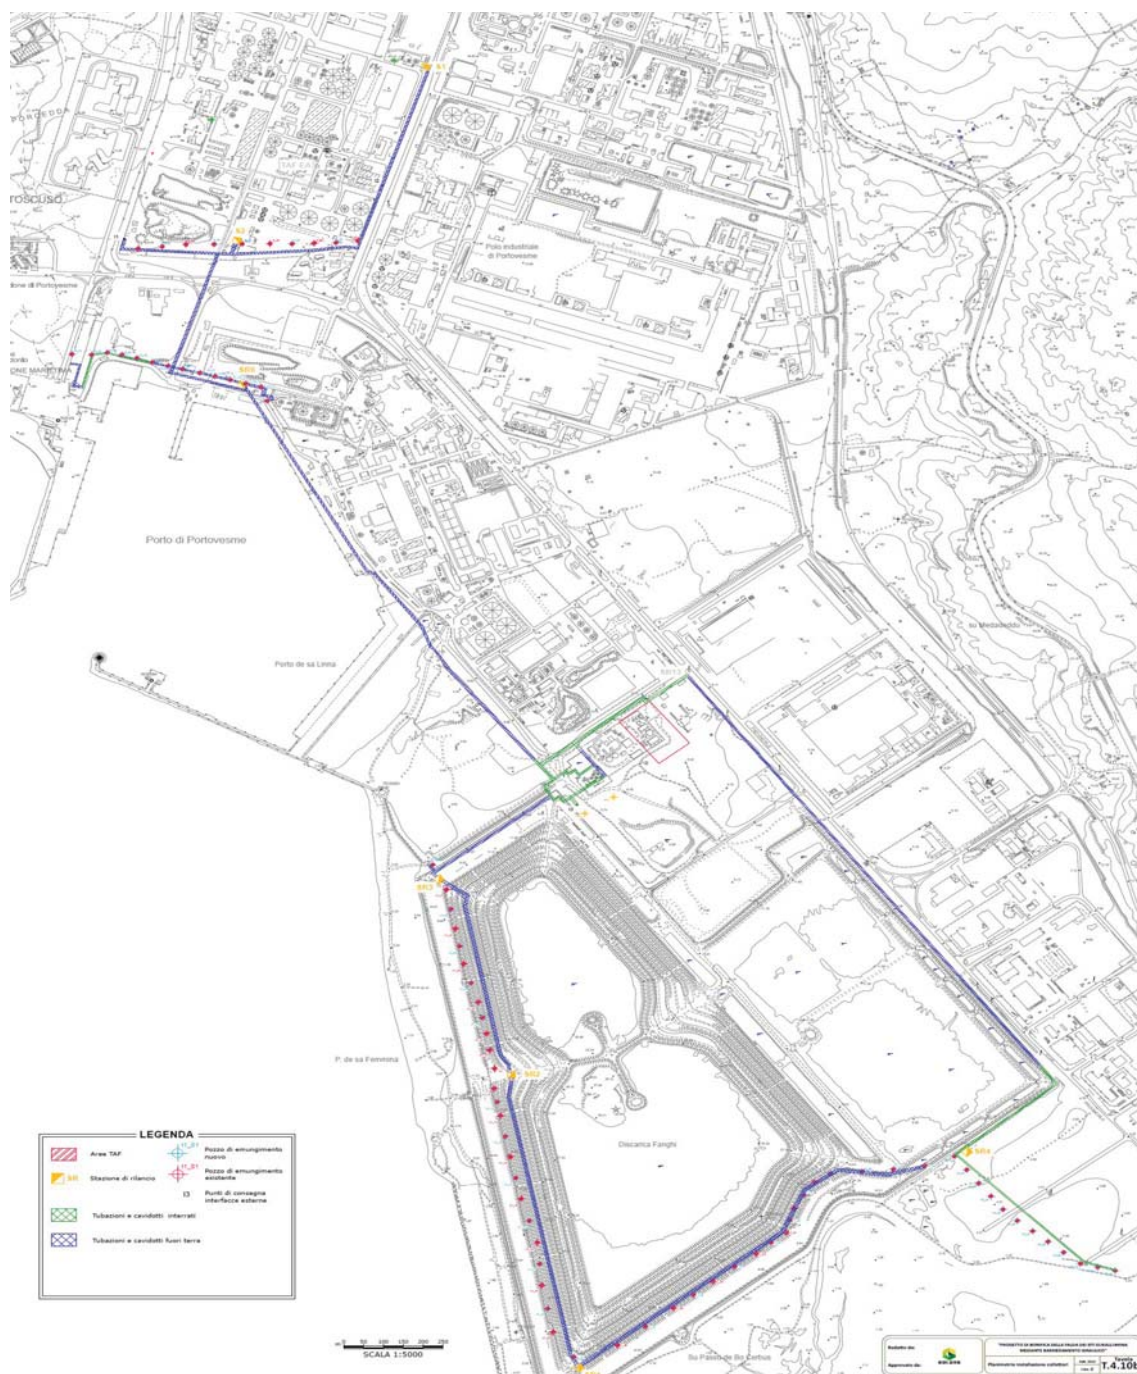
Rappresentazione planimetrica delle opere previste nell'intervento
